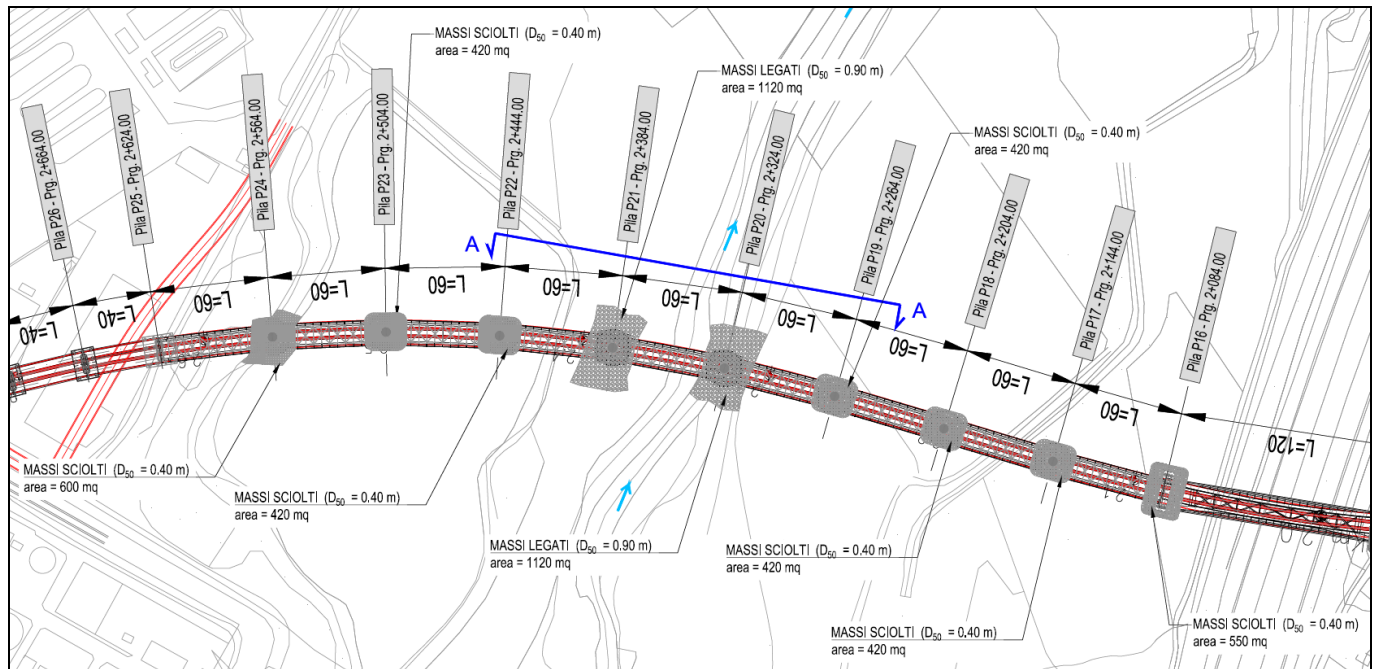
Viadotto VI21: opere di protezione previste in corrispondenza delle pile interessate dalla piena di progetto.
